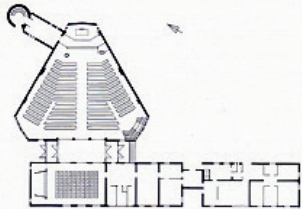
Augsburg-Kriegshaber, St.-Thomas-Kirche, 1960–1961, Grundriss
